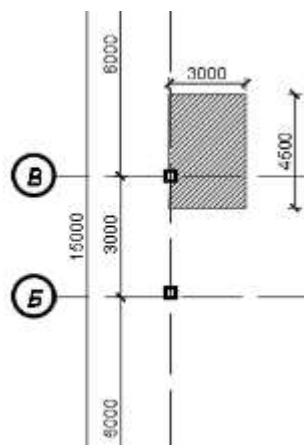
Грузовая площадь наиболее нагруженной крайней колонны
